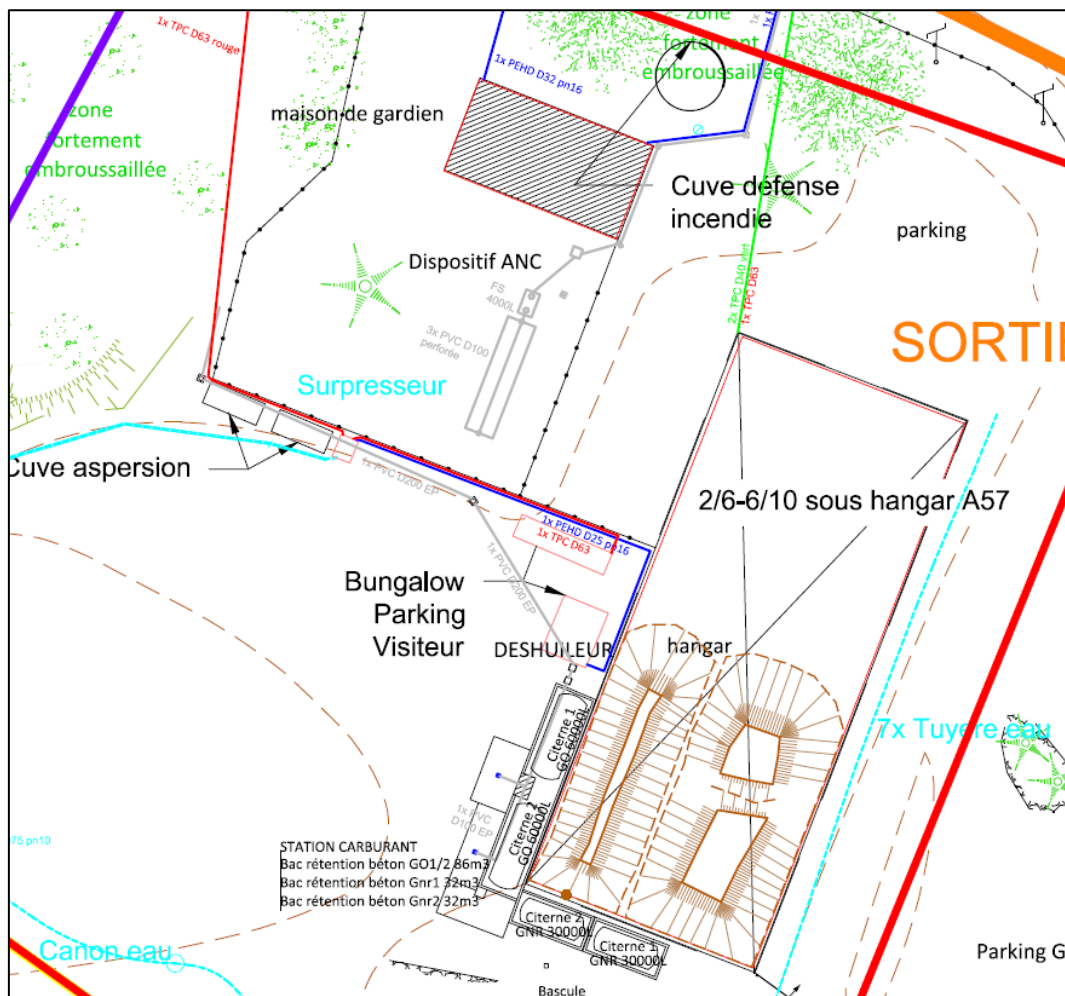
Extrait - Plan des réseaux de collecte au niveau de l'aire carburant (Source : SOTEM)
